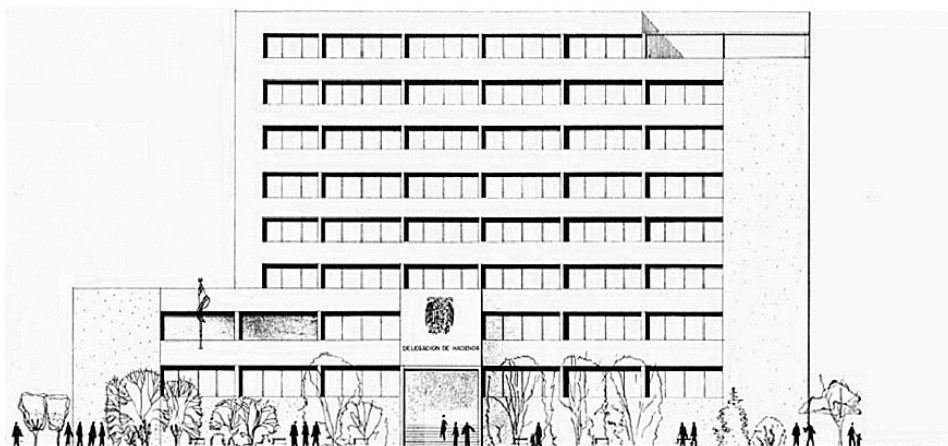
R. Teruel, anteproyecto para Delegación en Málaga, abril de 1966. Alzado principal.
